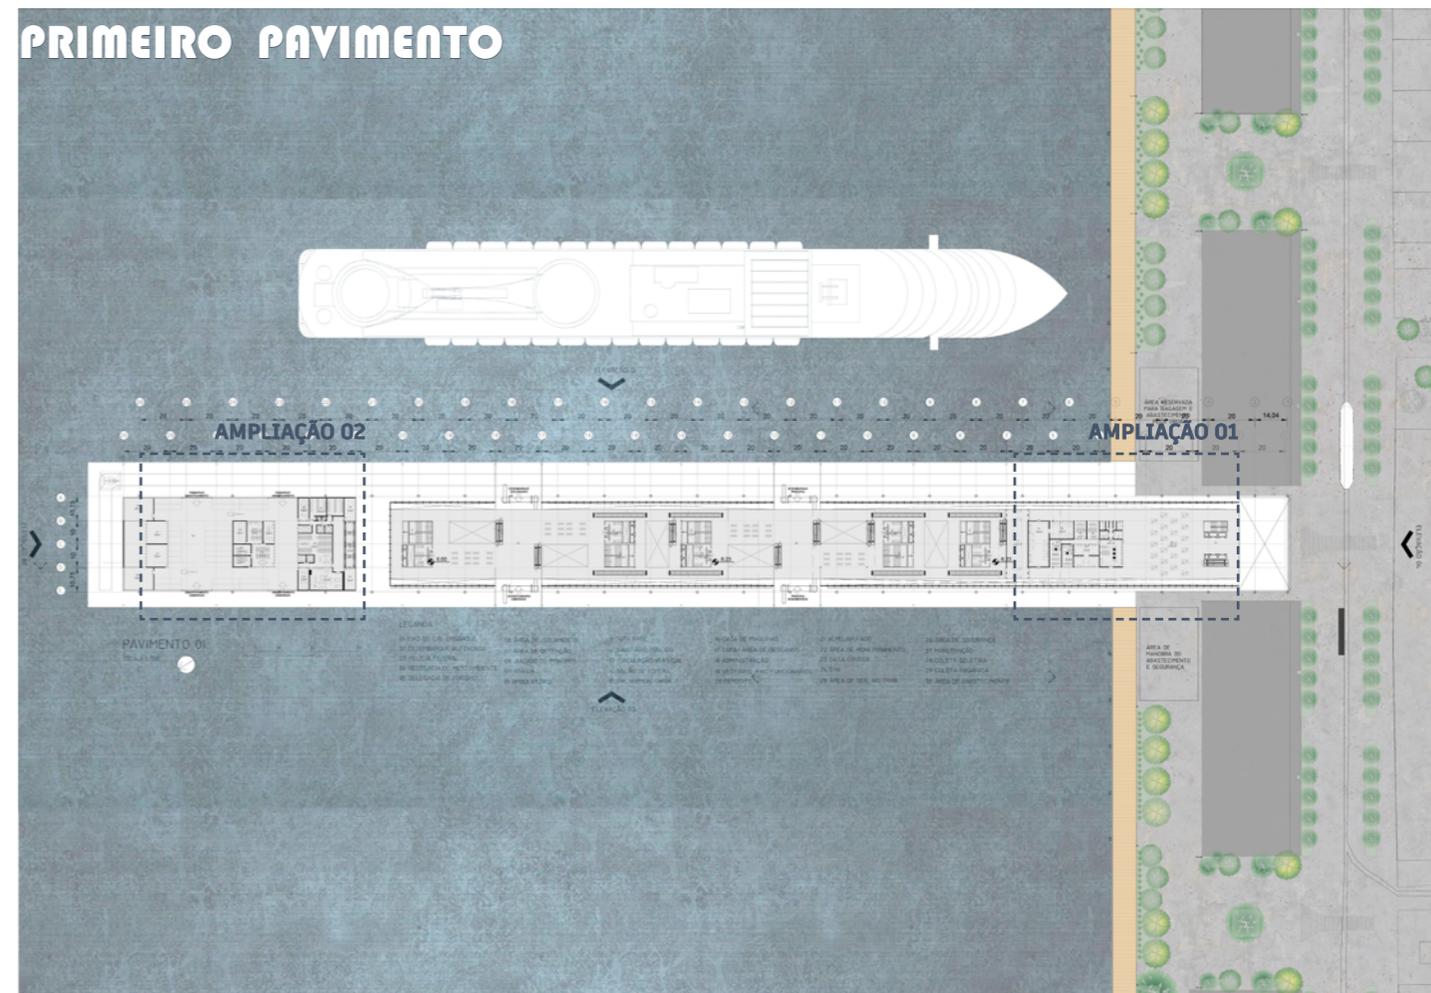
Planta do Primeiro pavimento. Fonte: Autoria própria.
